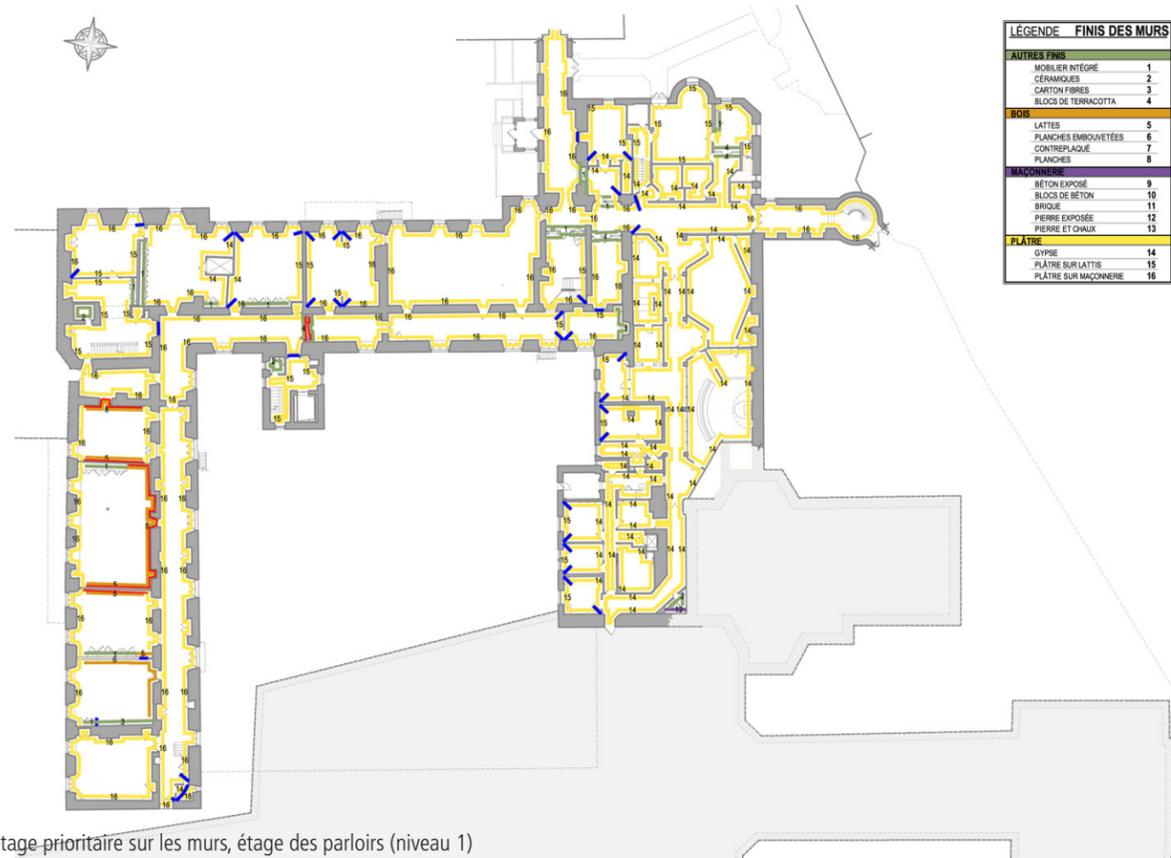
Plan de curetage prioritaire sur les murs, étage des parloirs (niveau 1)
